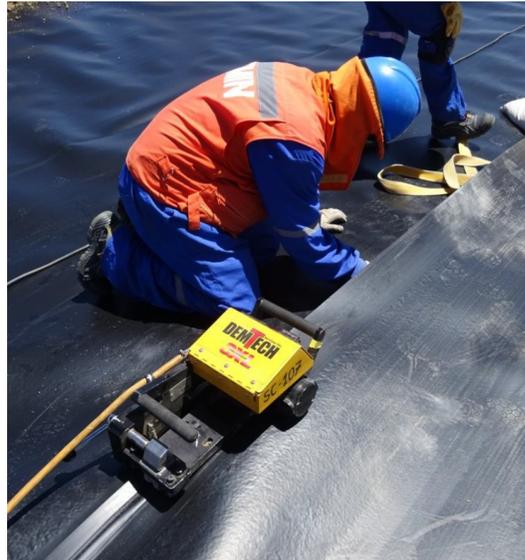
Equipo de soldadura por cuña caliente.
